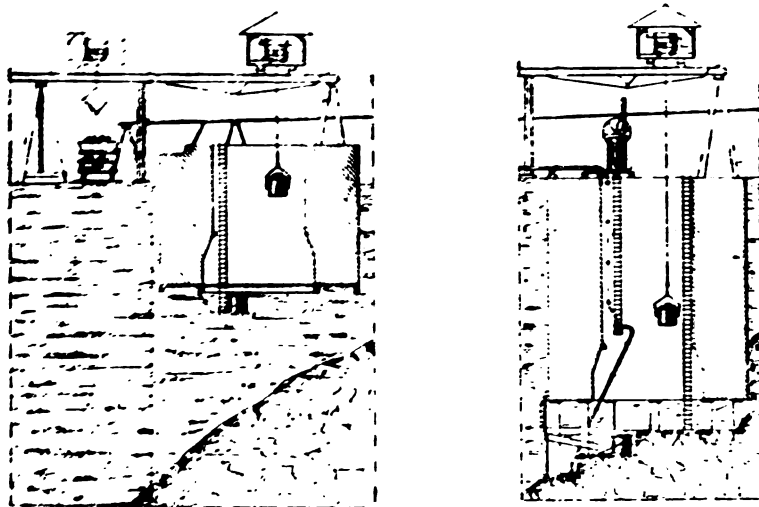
Bordeaux — Coupe des fondations du bassin de radoub.
